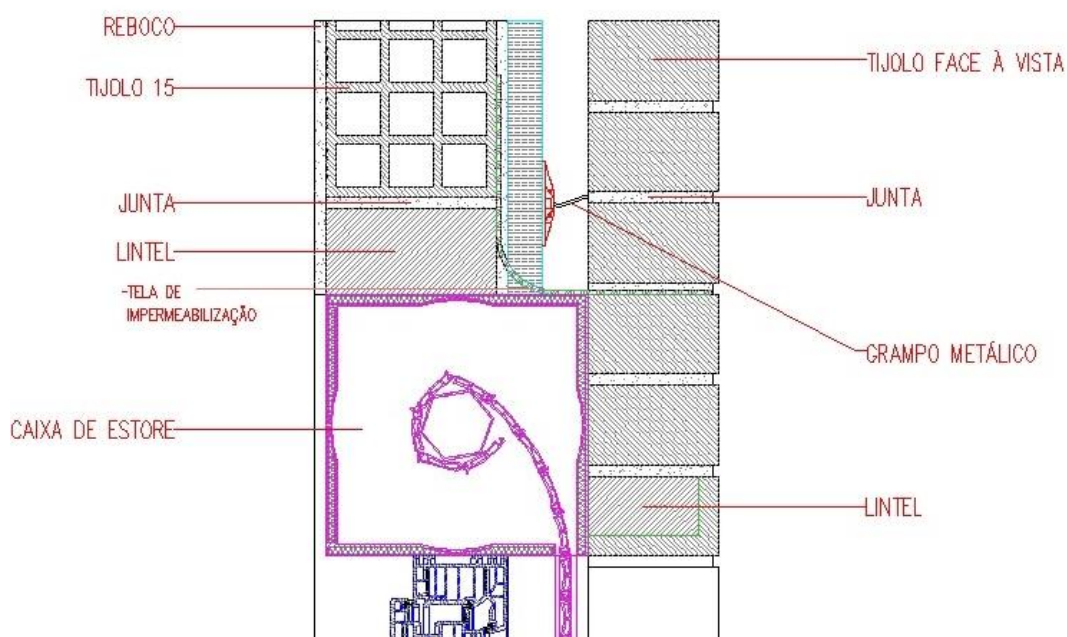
Corte em zona de lintel, com destaque para a impermeabilização [17]
